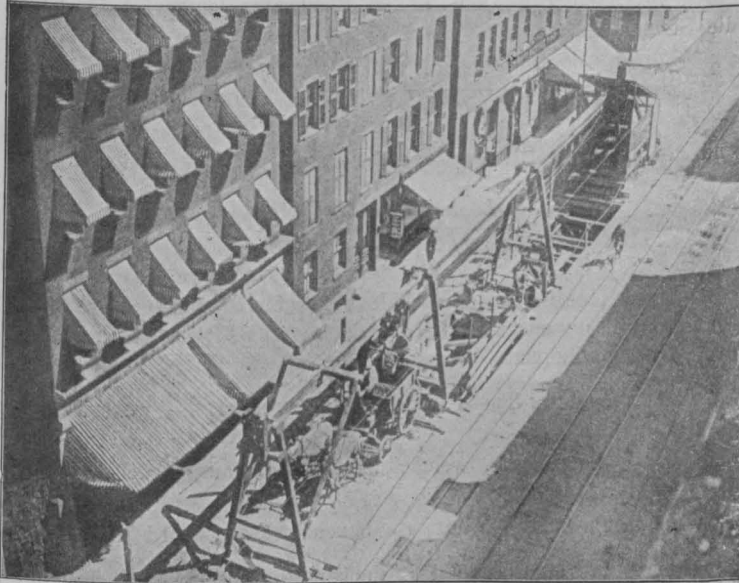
Maschineller Aushub mit Querschnitt in Section 4.
